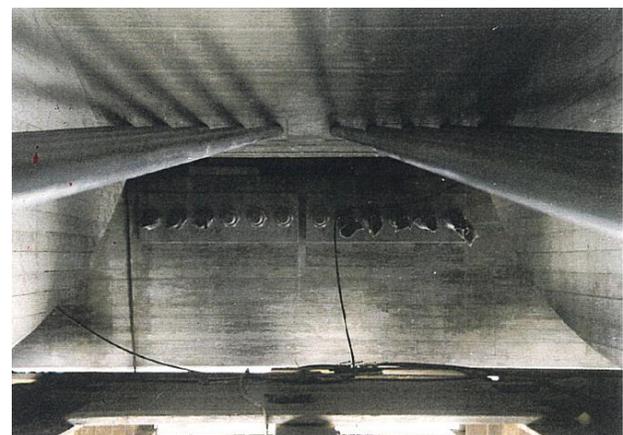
Übergang Einhängeträger/ Kragträger-obenliegend Spannglieder des Einhängeträgers unten Verankerung der langen Spanngliedzüge des Kragträgers, links und rechts ist gut die Fischbauchform der Innenträger des Stahlbeton-Plattenbalkens zu erkennen, Bild stammt vom Neubau August 1995
